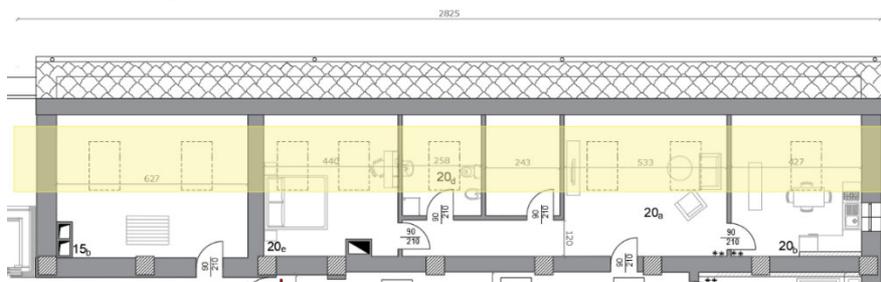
Stralcio della pianta primo, sottotetto abitabile.
